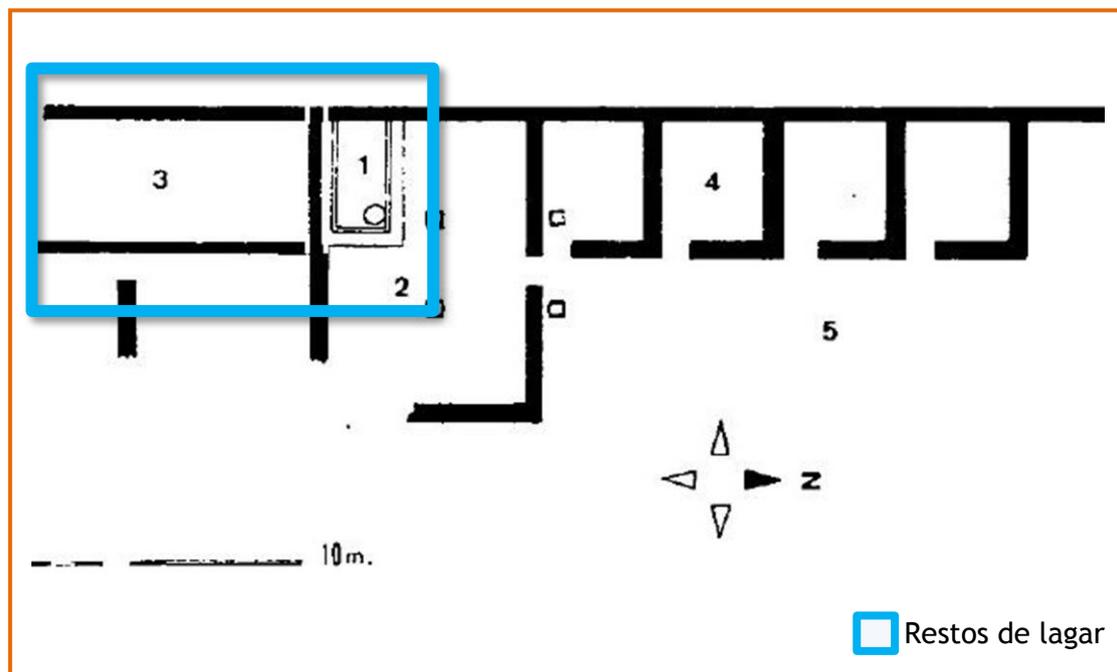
Planimetría de los restos de la villa de Falces (Navarra). AGUILAR
